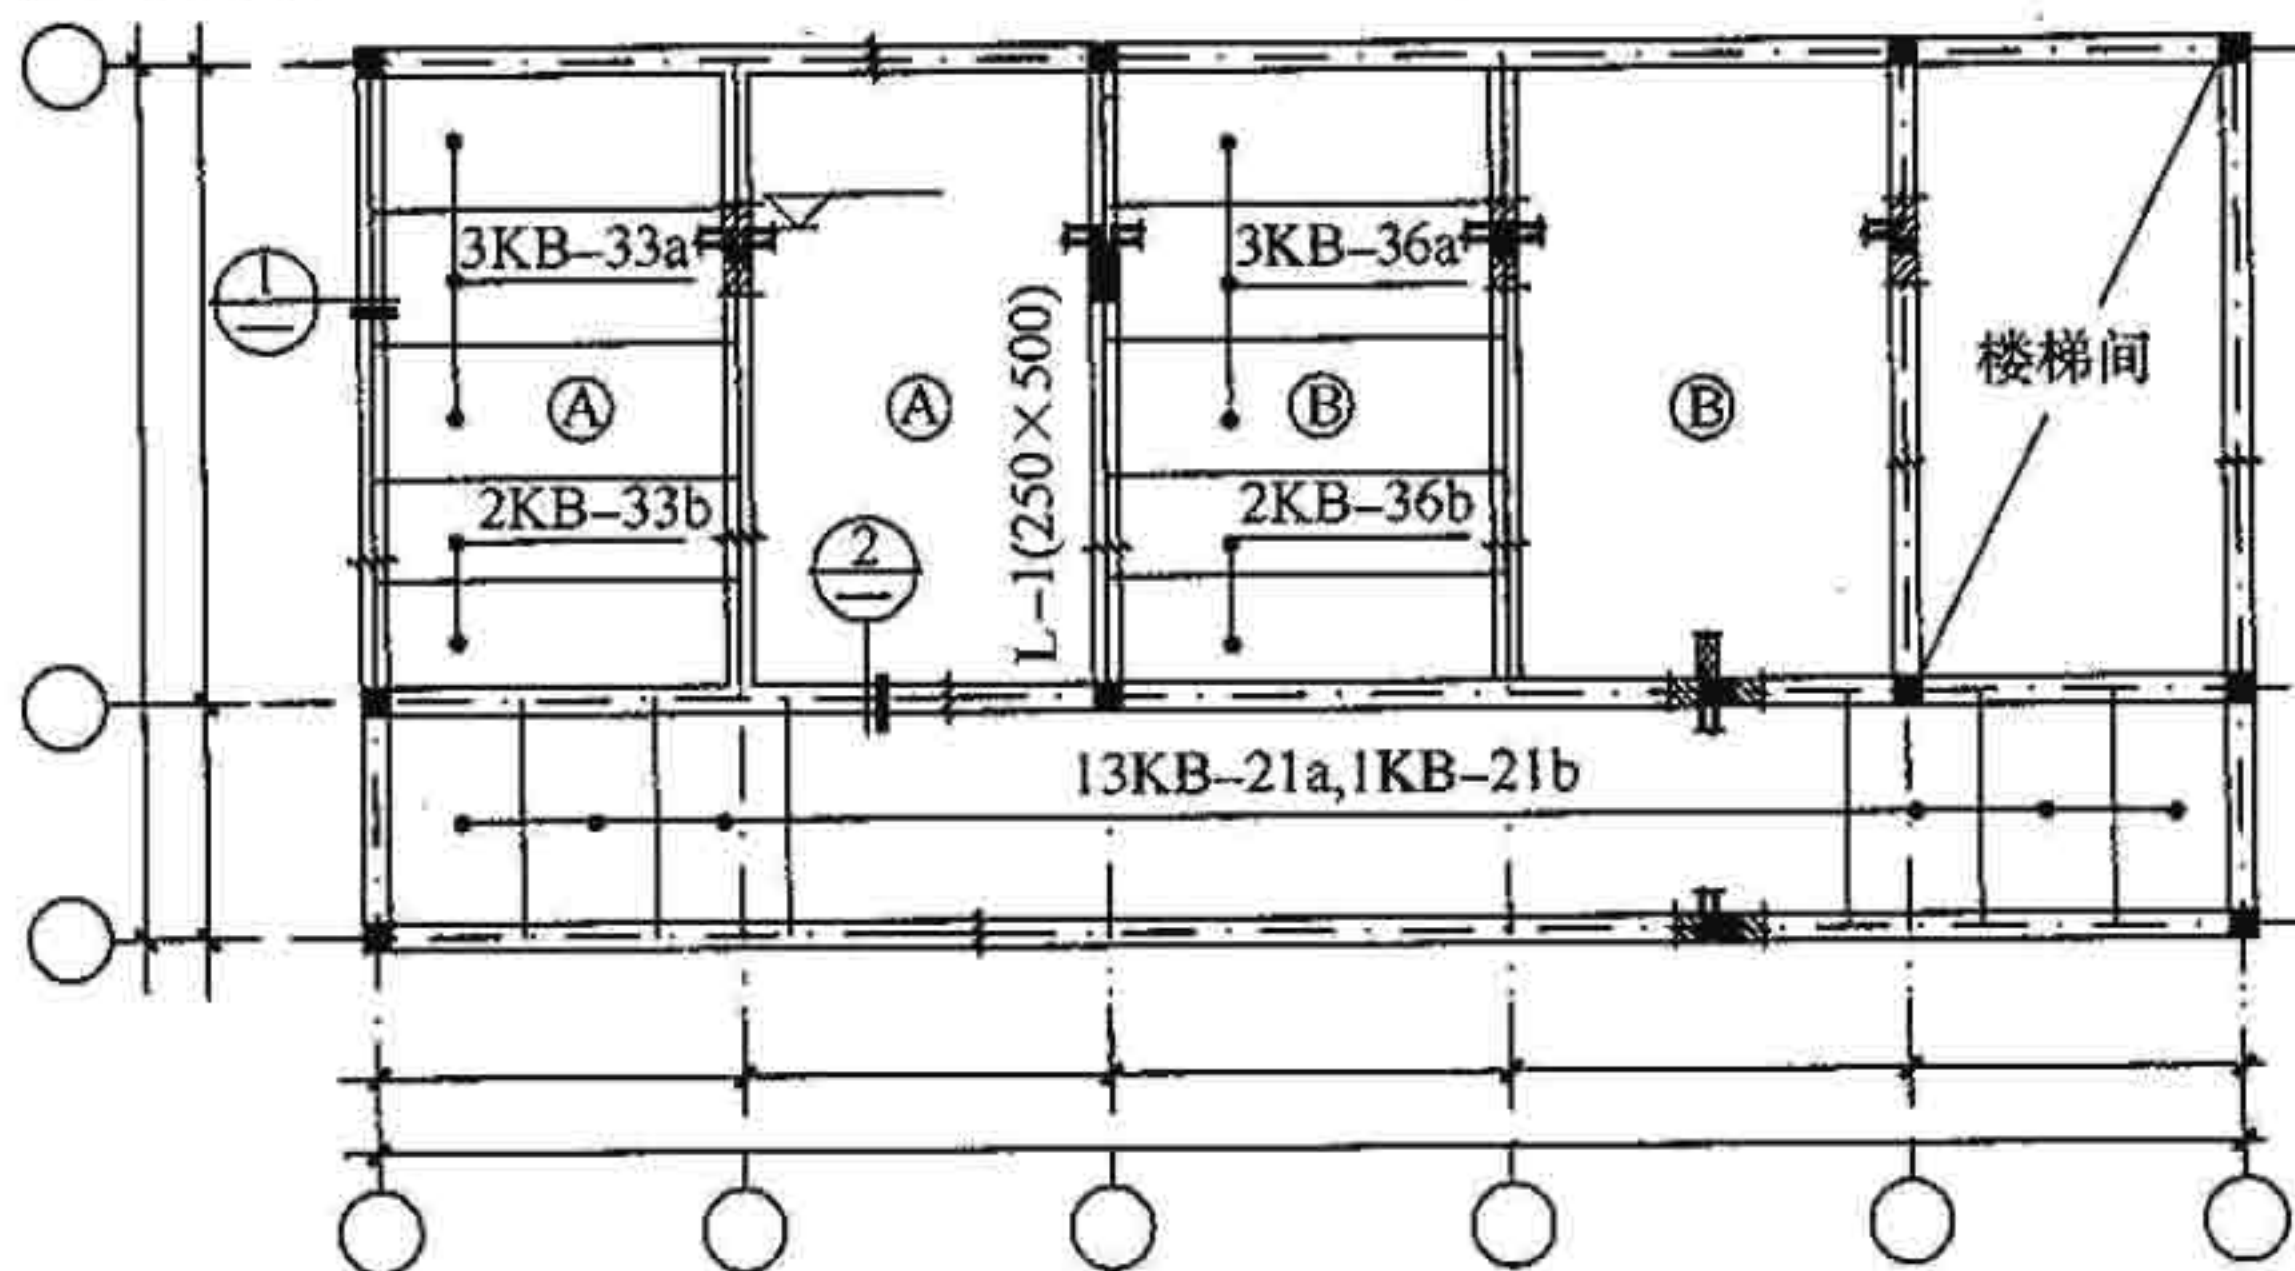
用正投影法绘制预制楼板结构平面图
